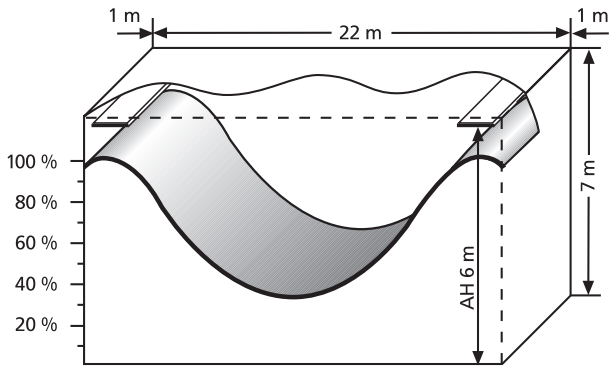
c Deckenstrahlflächen im Aussenbereich
